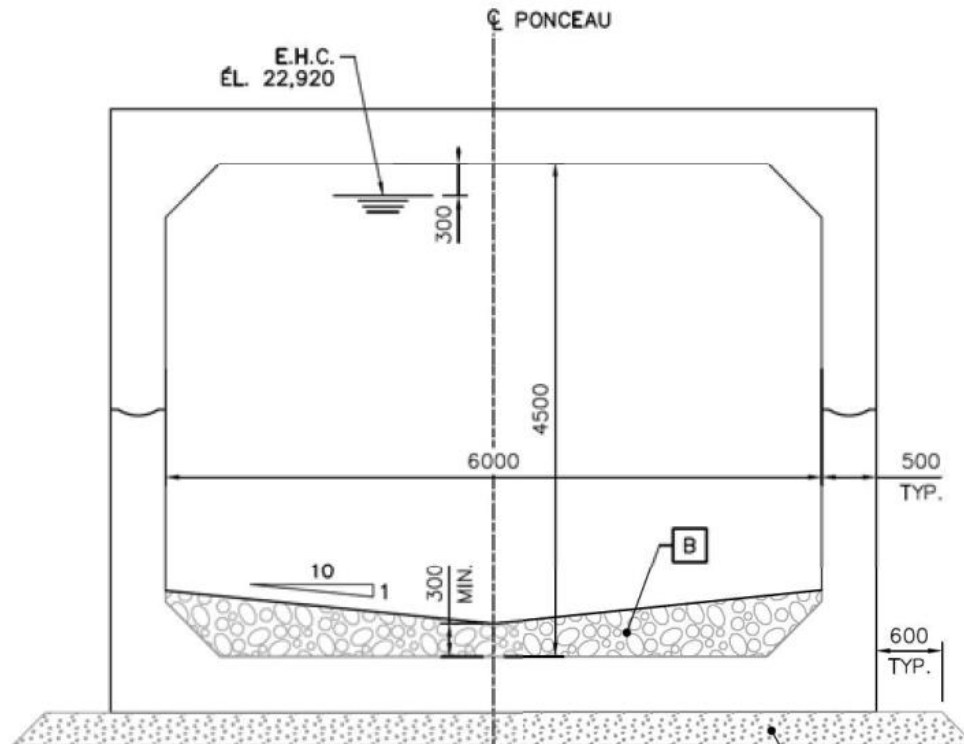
Coupe type du nouveau ponceau rectangulaire dans la jetée sud
